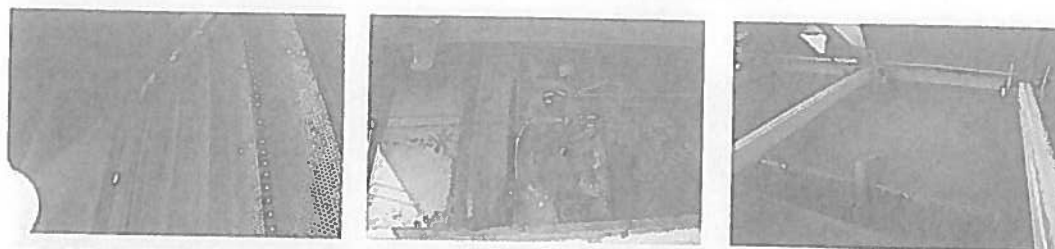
TP03 Bovenanzicht vet- en zandverwijderingsinstallatie
